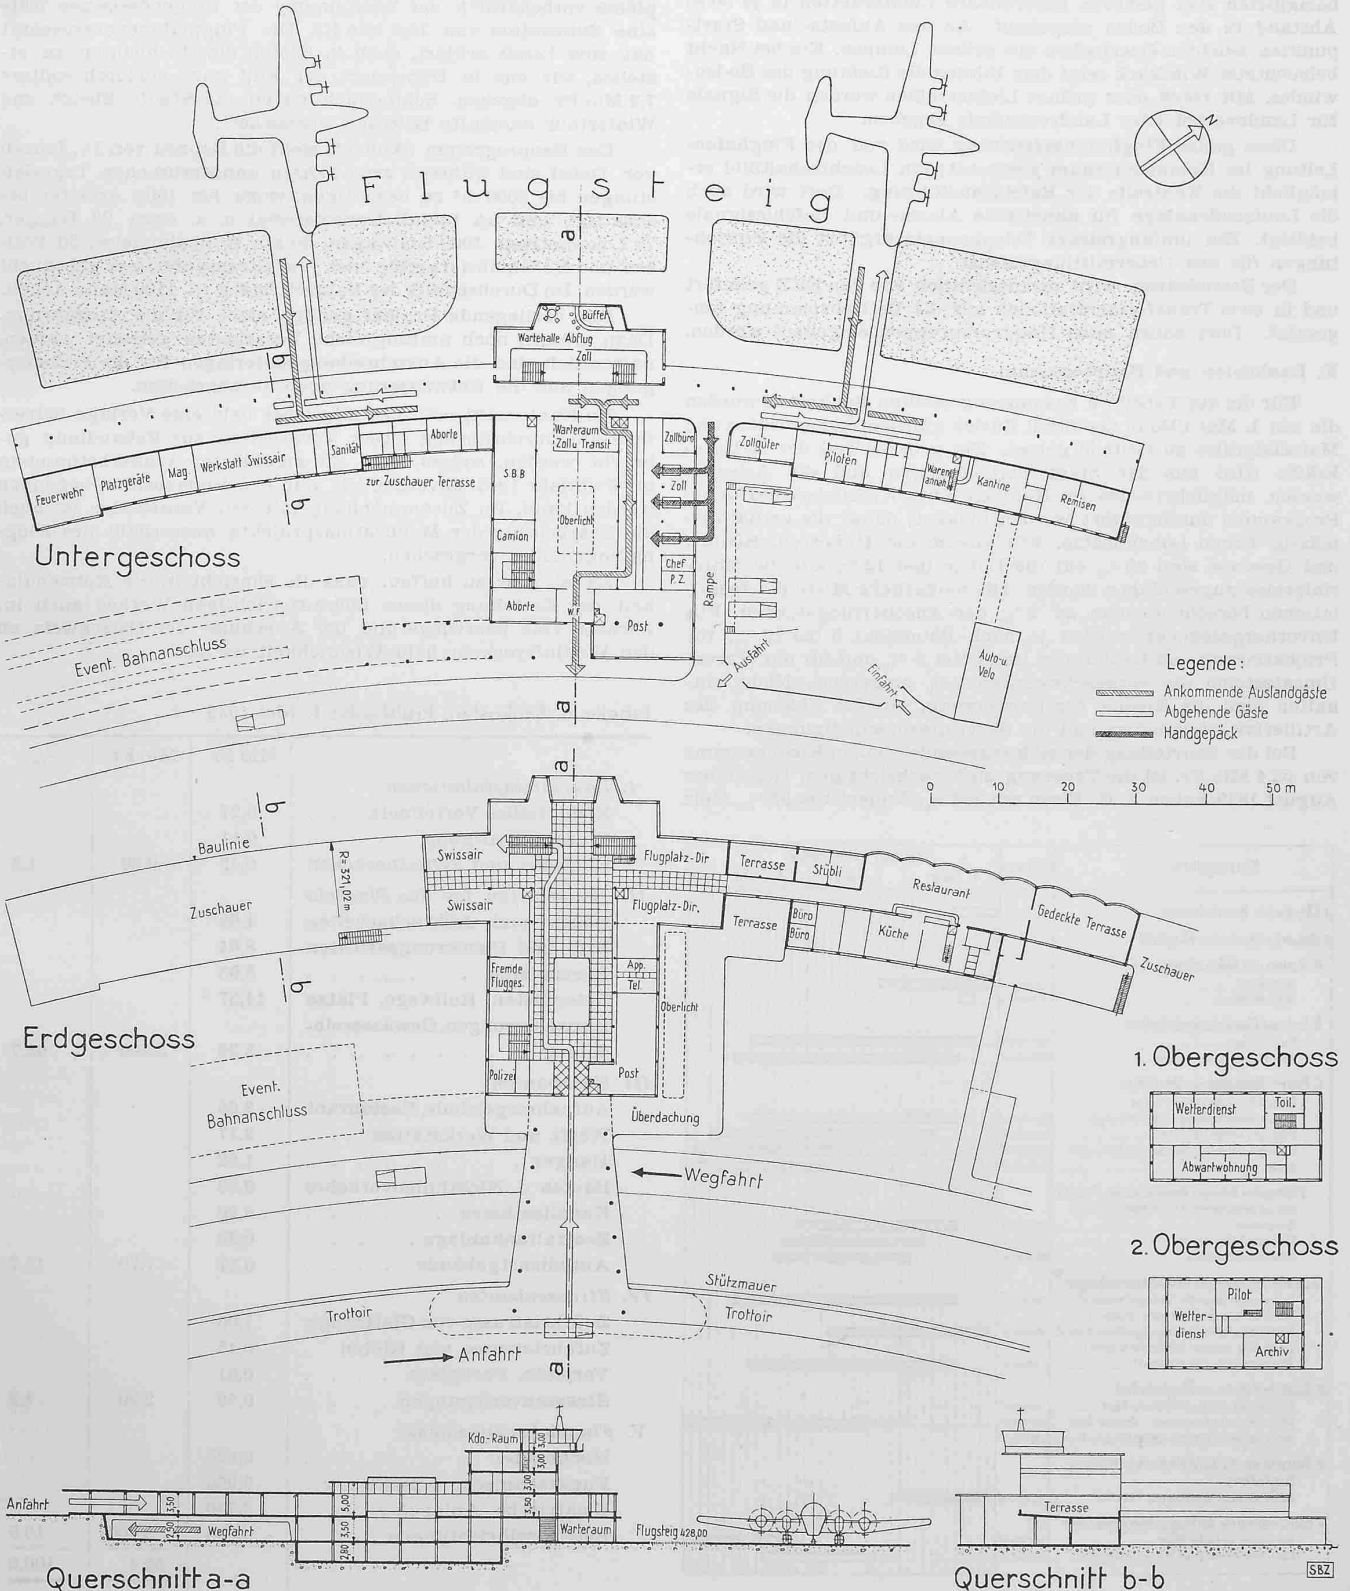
Aufnahmegebäude, Grundrisse und Schnitte 1 : 1000
